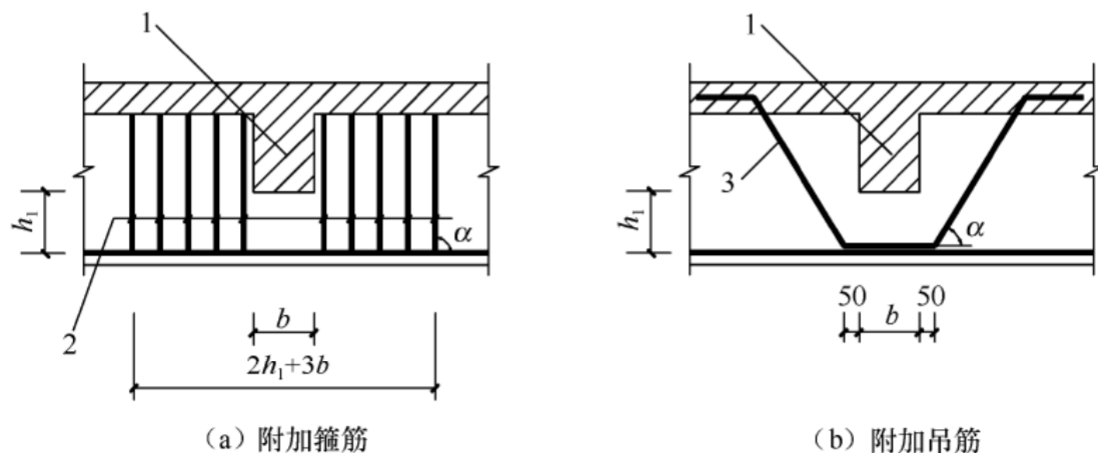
梁截面高度范围内有集中荷载作用时附加横向钢筋的布置
